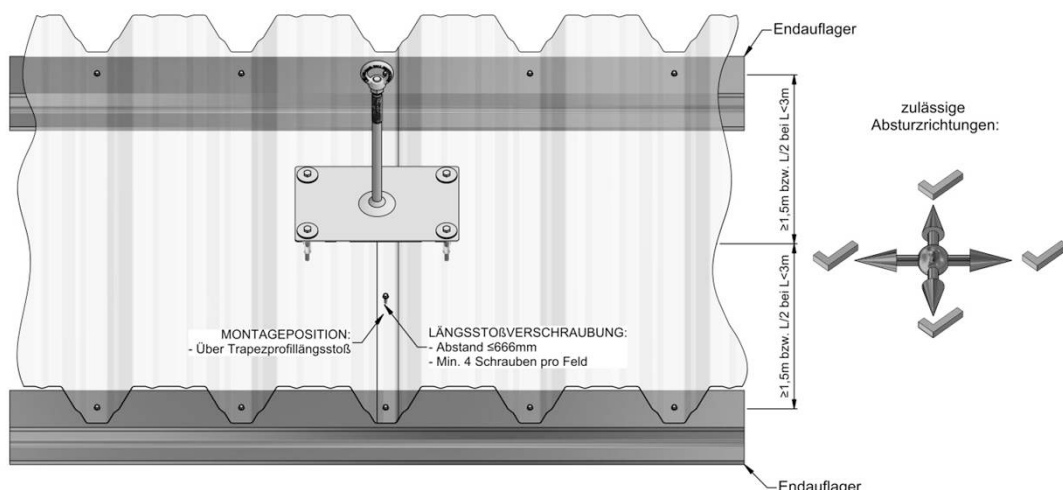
Montagevorgaben auf Trapezprofil (Positivlage) bei Absturzrichtung quer zur Trapezprofilspannrichtung
